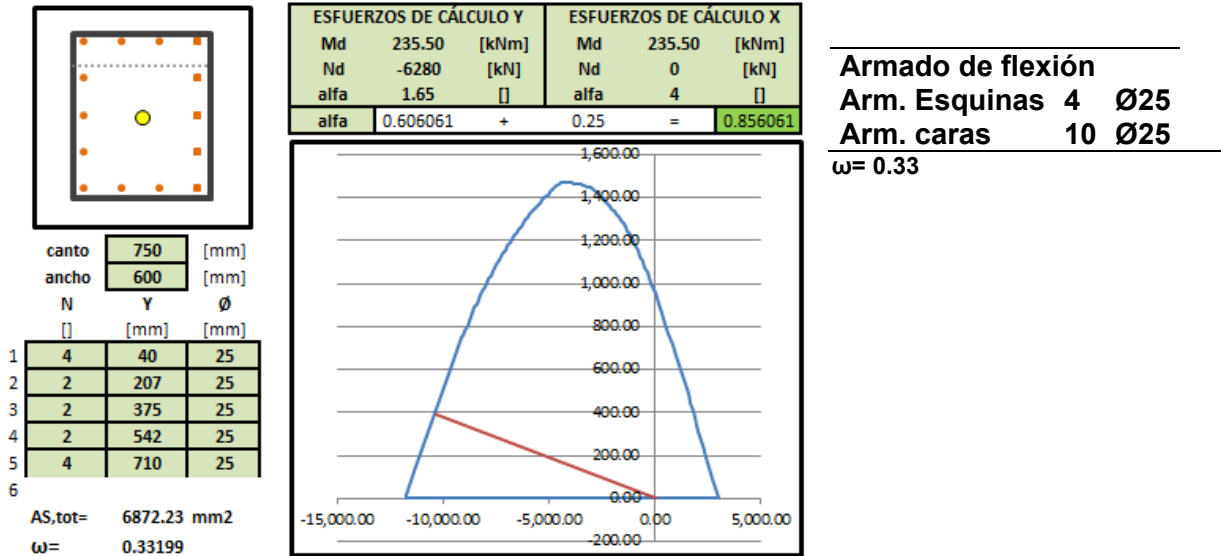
Armado pilar 75x60cm. Fuente: Elaboración propia
